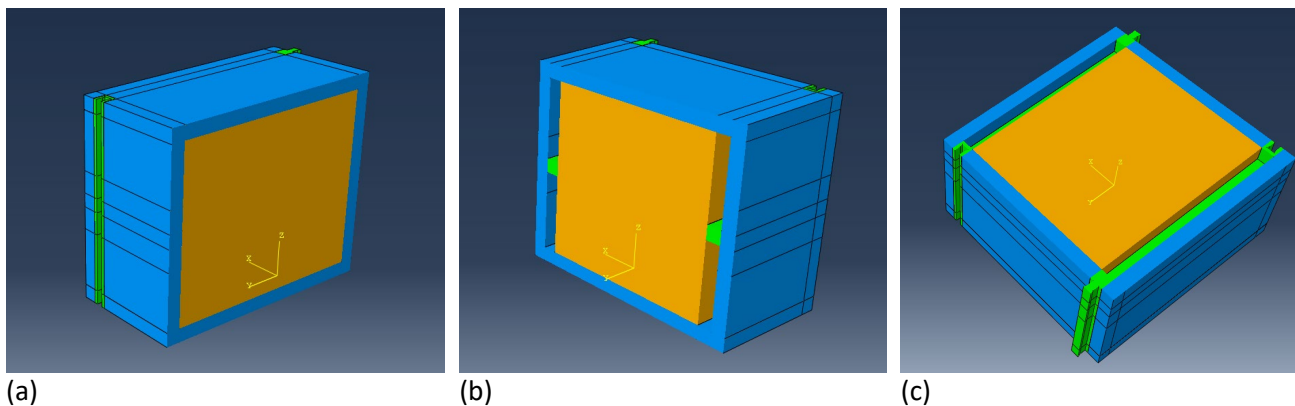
(a) Sezione verticale 1; (b) Sezione verticale 2; (c) Sezione orizzontale.
